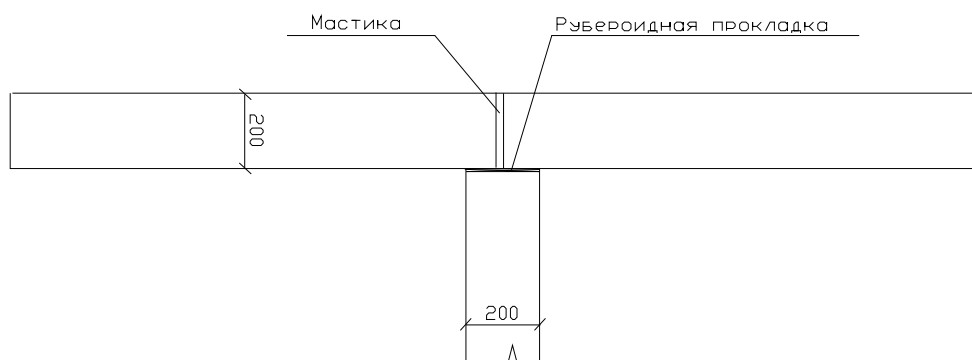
Стык стеновых панелей на ранних этапах крупнопанельного домостроения (горизонтальный разрез).
